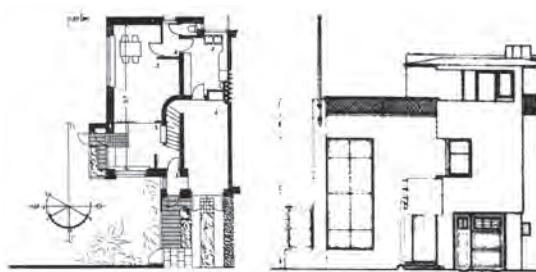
Disegni della pianta del piano terra e del prospetto della Casa a Niegolewskiego Street.
